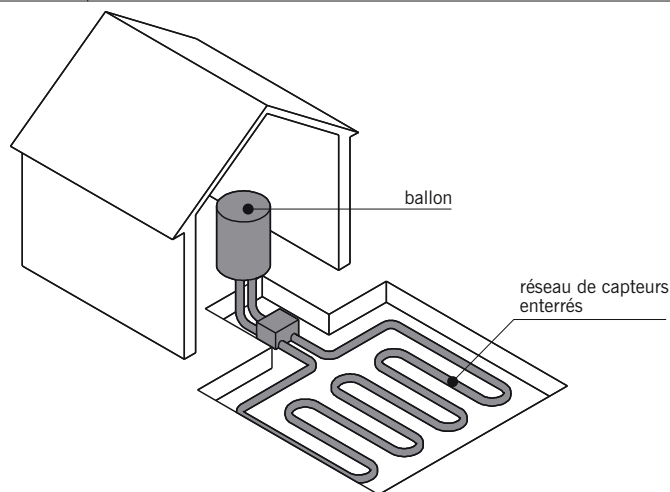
schéma d'une installation de chauffe-eau géothermique
